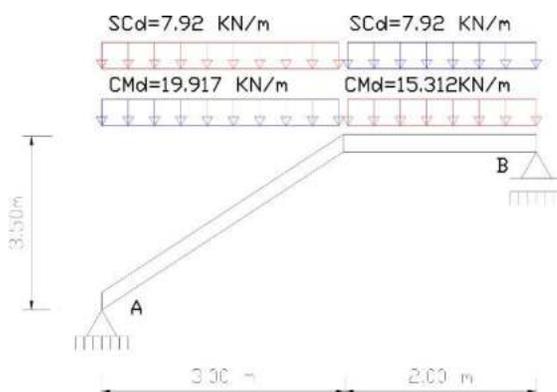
Consideración de la escalera para el cálculo de la armadura principal.
